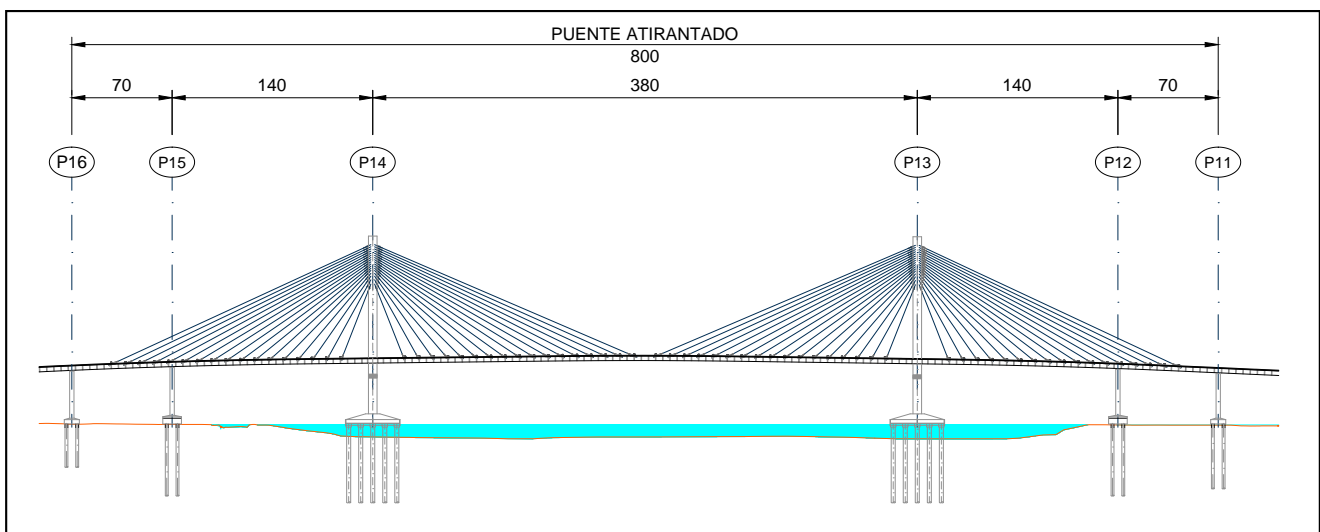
Alzado del tramo atirantado del nuevo Puente Pumarejo.
